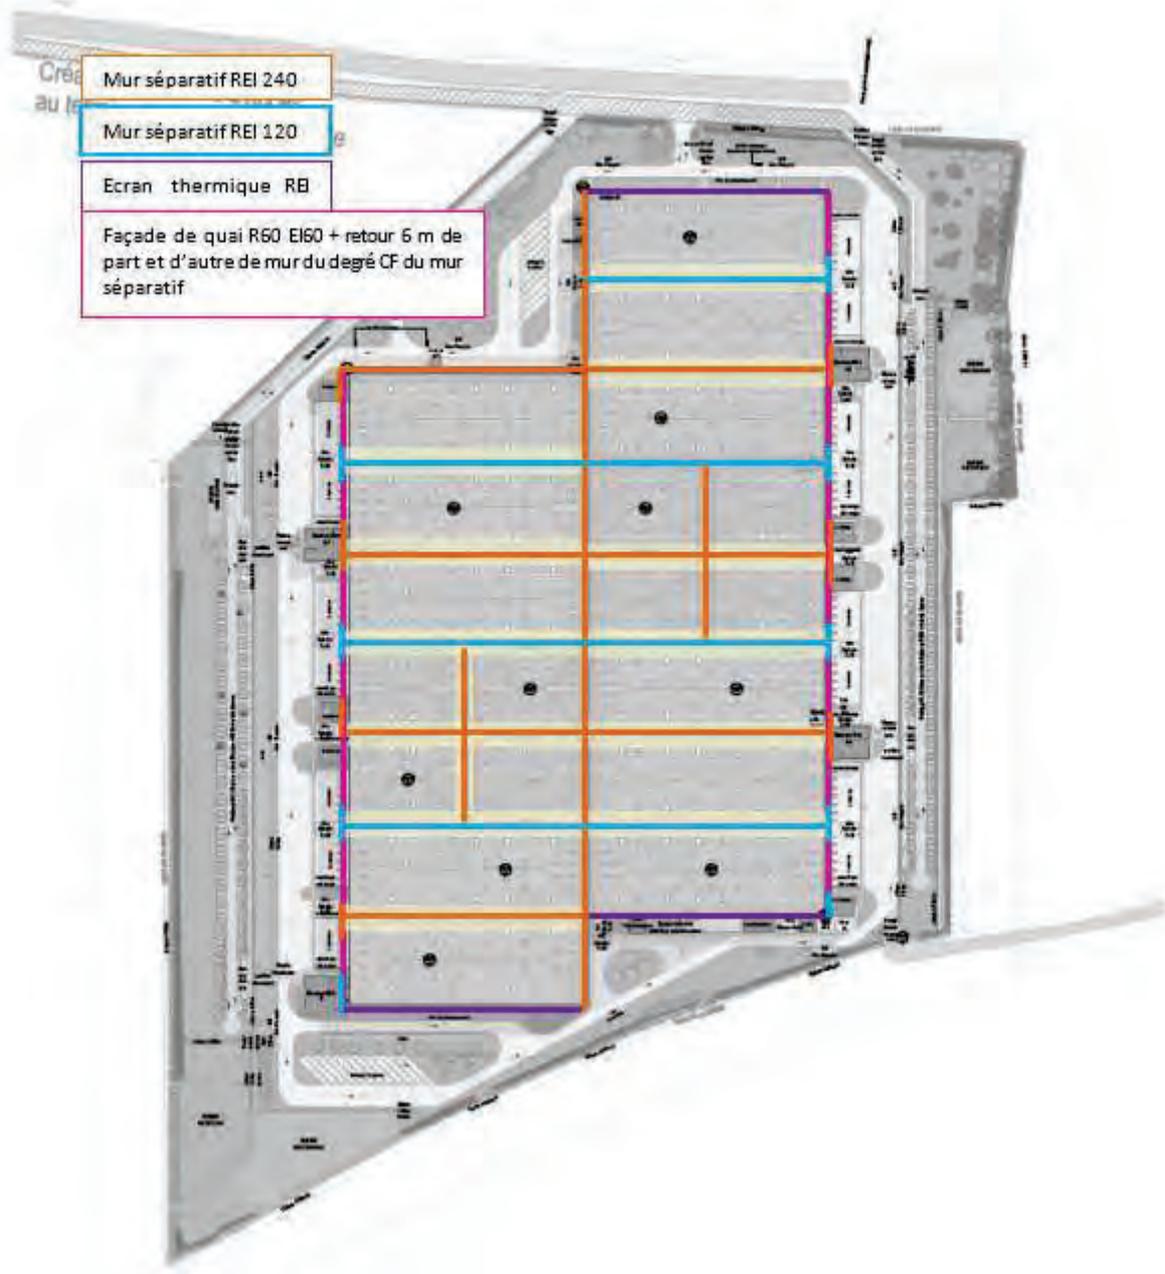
Plan de repérage des murs coupe-feu sur le bâtiment.
